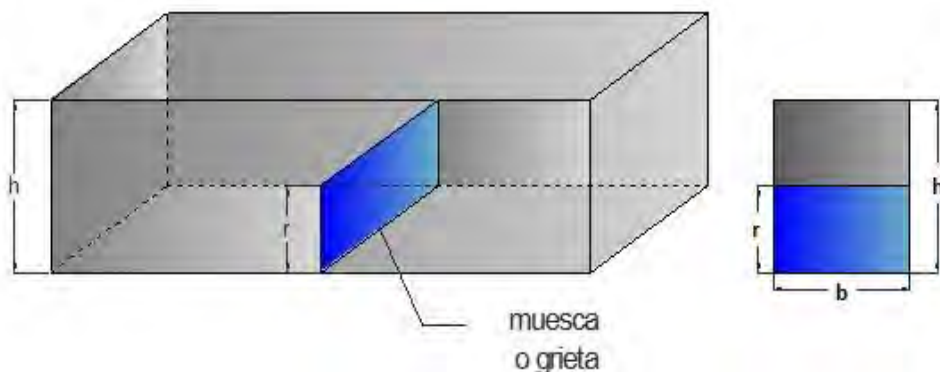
Representación de agrietamiento en viga de concreto simple.
